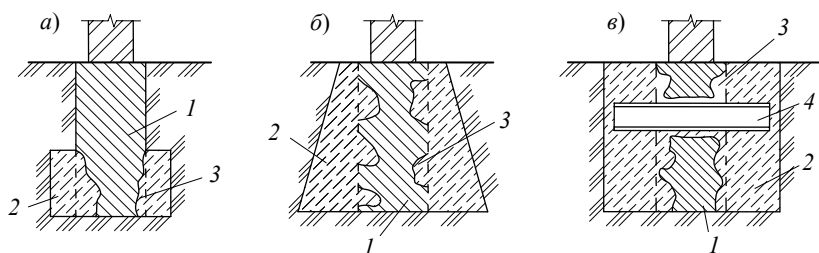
Схемы усиления ленточных фундаментов бетонными облоймами:
